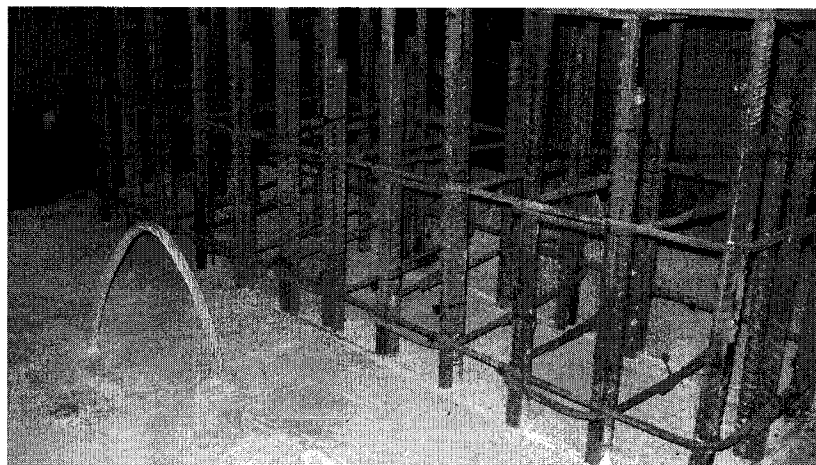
Installation de la cage d'armature du pilier 4 sur la semelle
